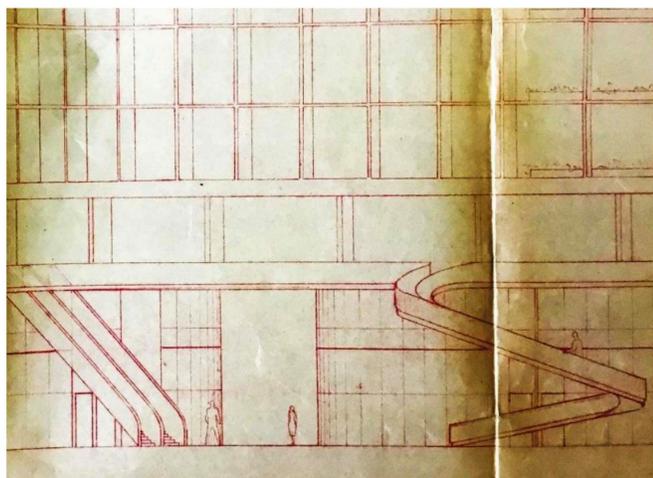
Vista parcial da Fachada Frontal com a rampa sem os pilares
